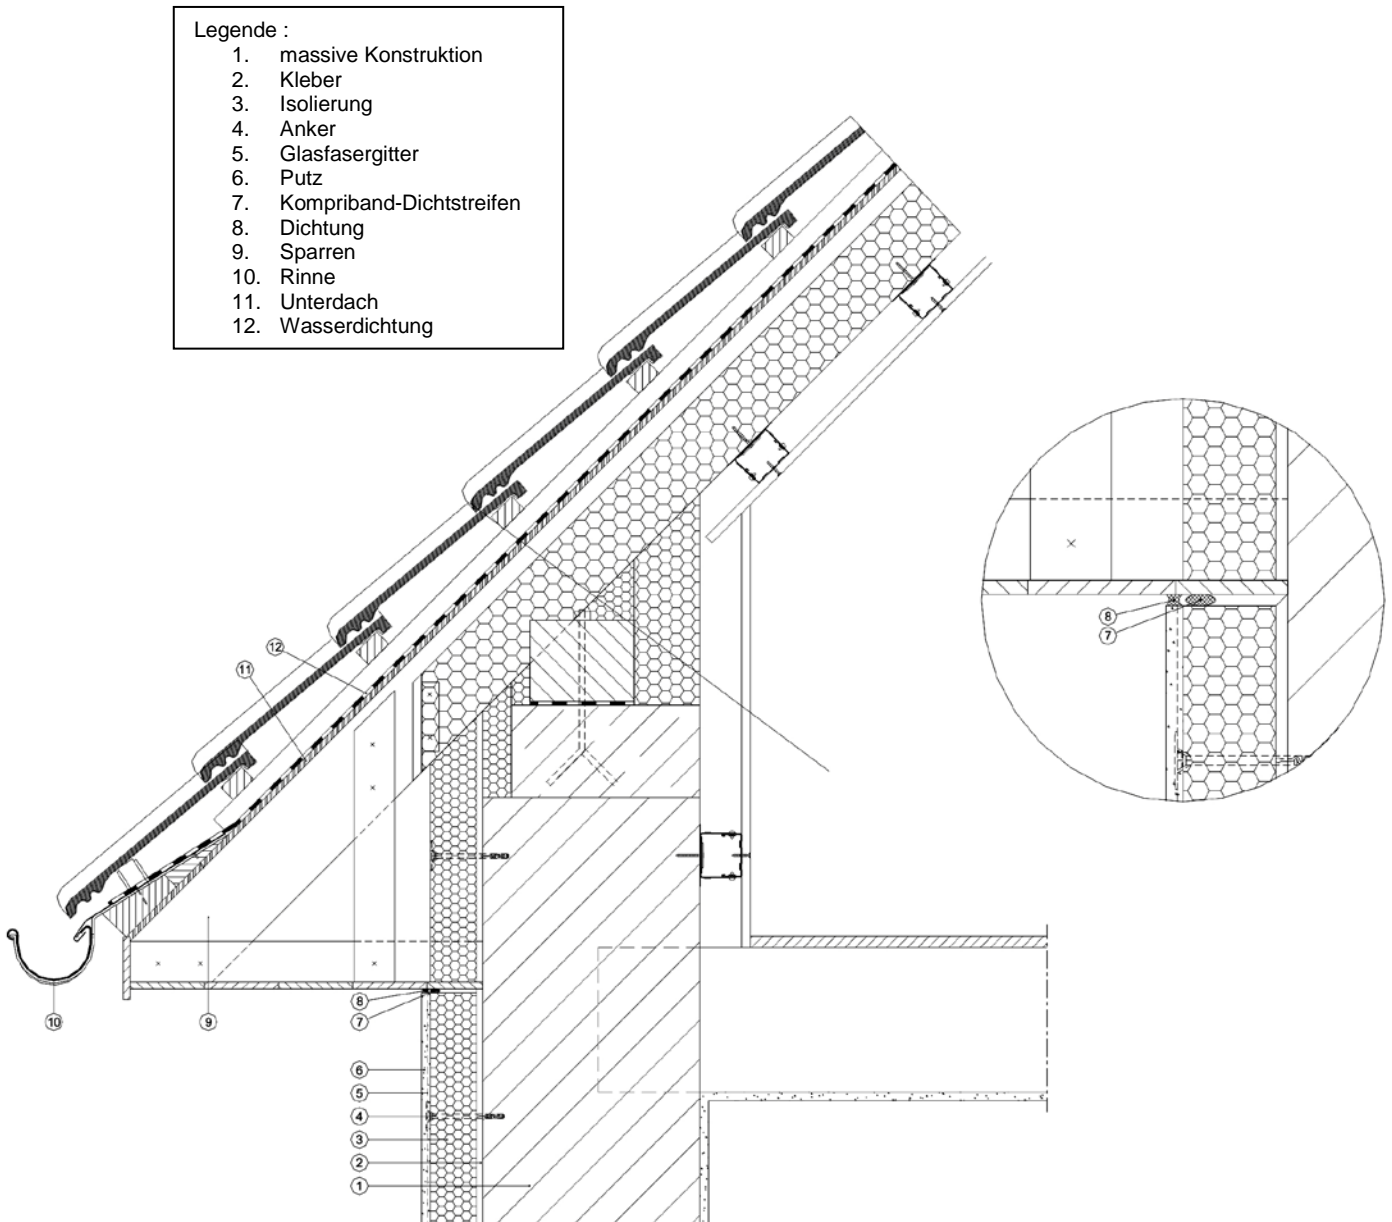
Bauliche Durchbildung einer schrägen Dacheinfassung
